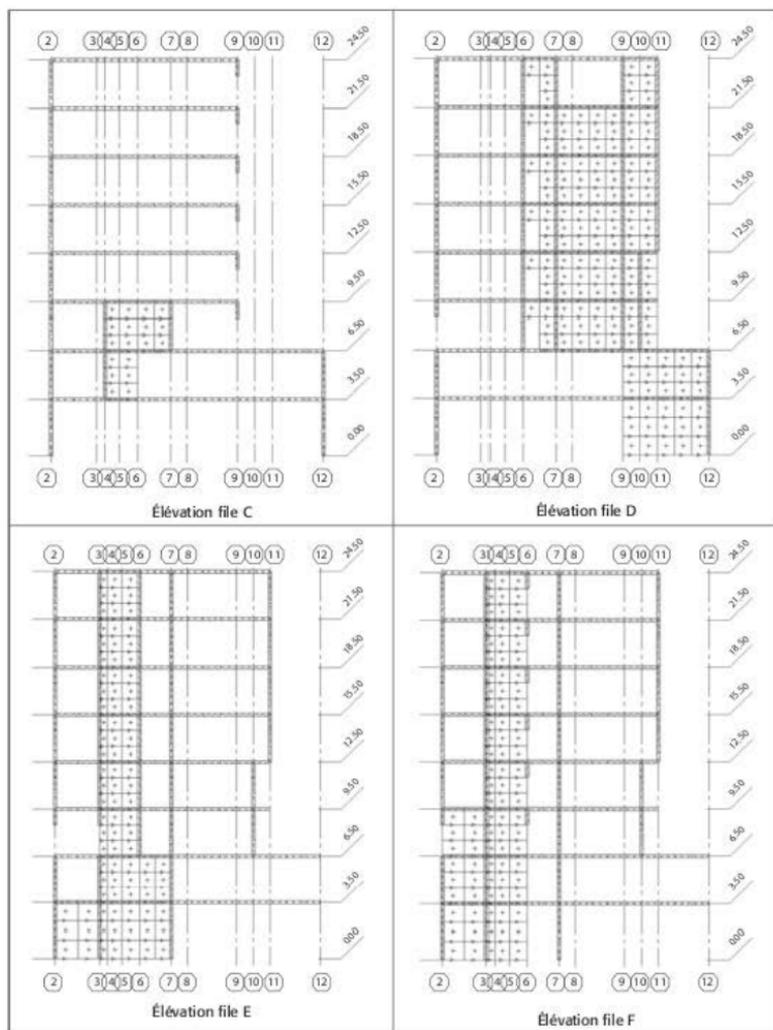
Élévation des voiles – plan XZ (2/4)
